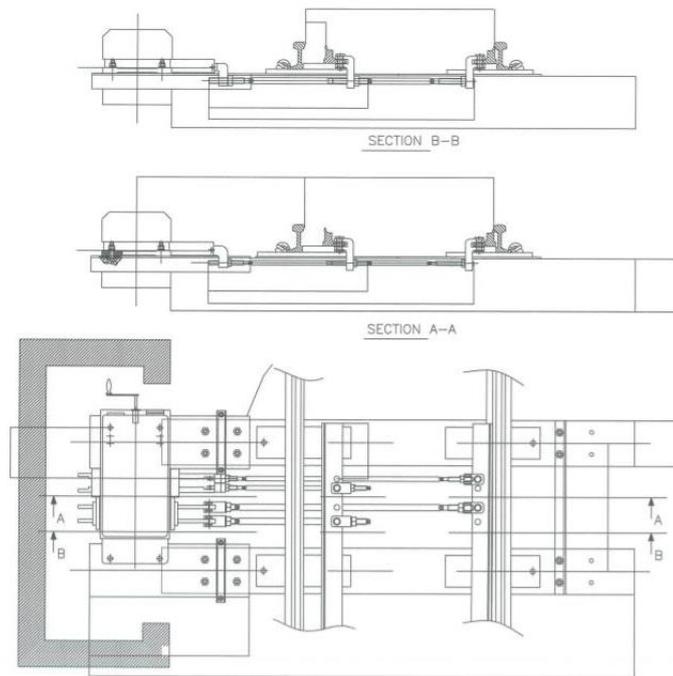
As Built Drawing Stasiun Tanah Abang
